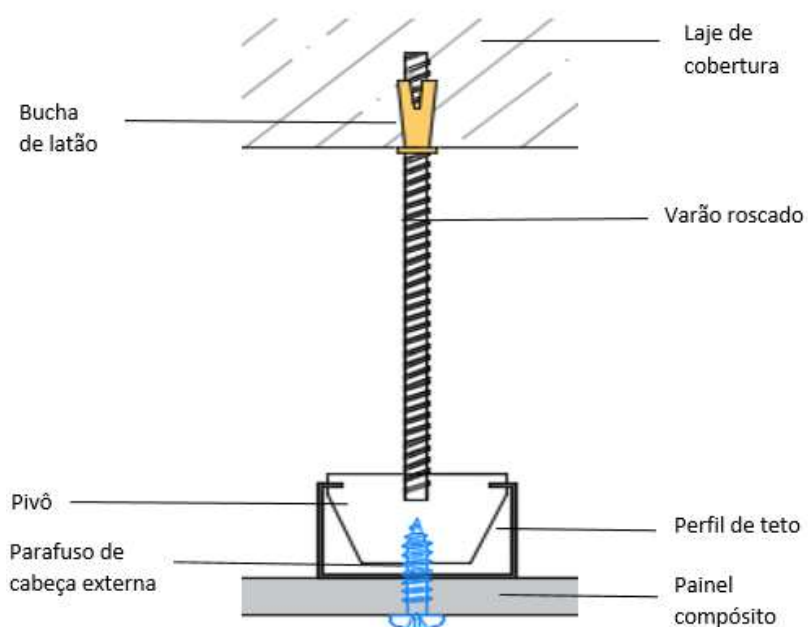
Pormenor construtivo nº4, fixação teto falso/estrutura de suporte.
